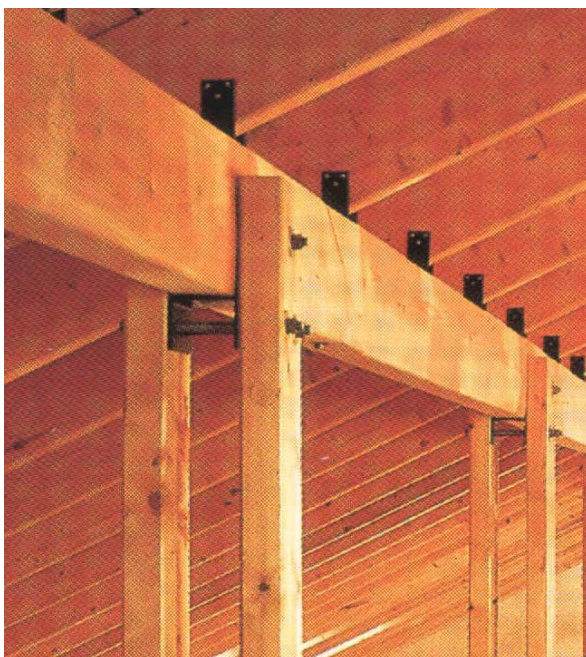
Detalle de uniones mecánicas viga-pilar.
